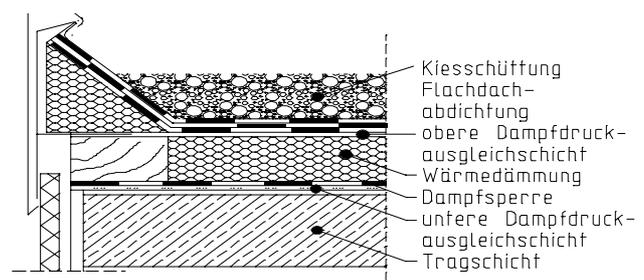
Aufbau Flachdach aus Stahlbeton.
